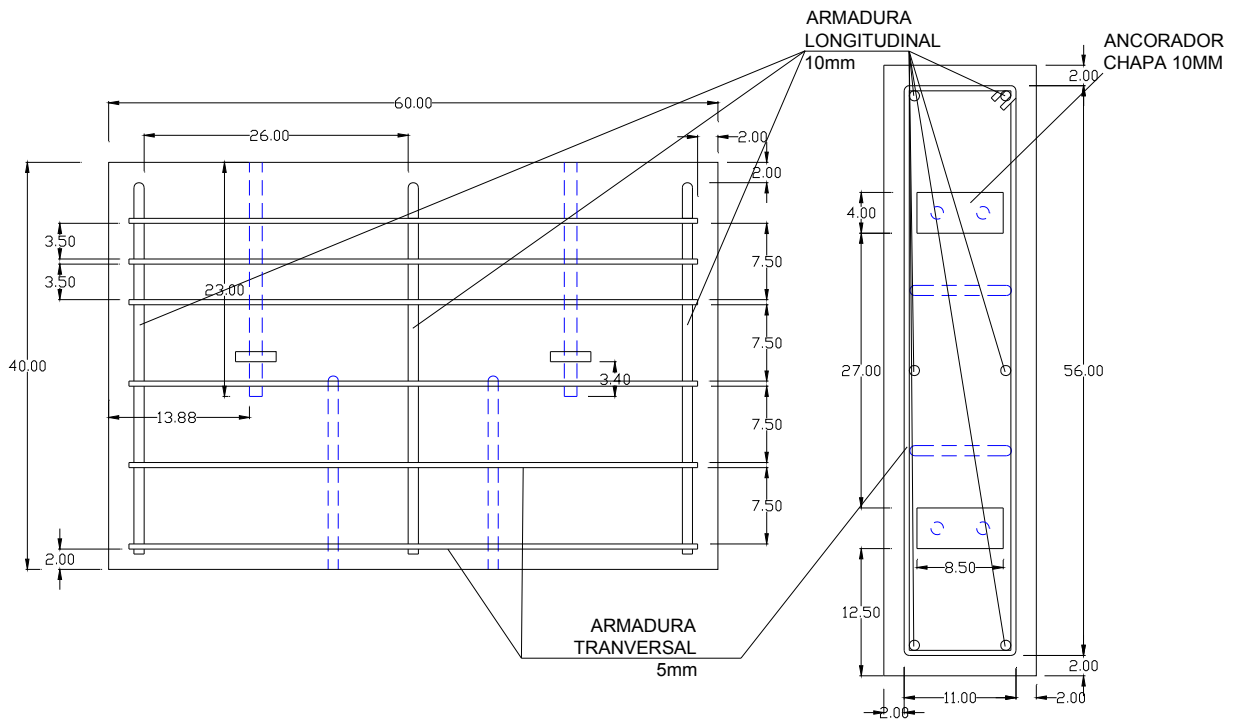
Detalhamento da armadura do pilar para o modelo 4.
